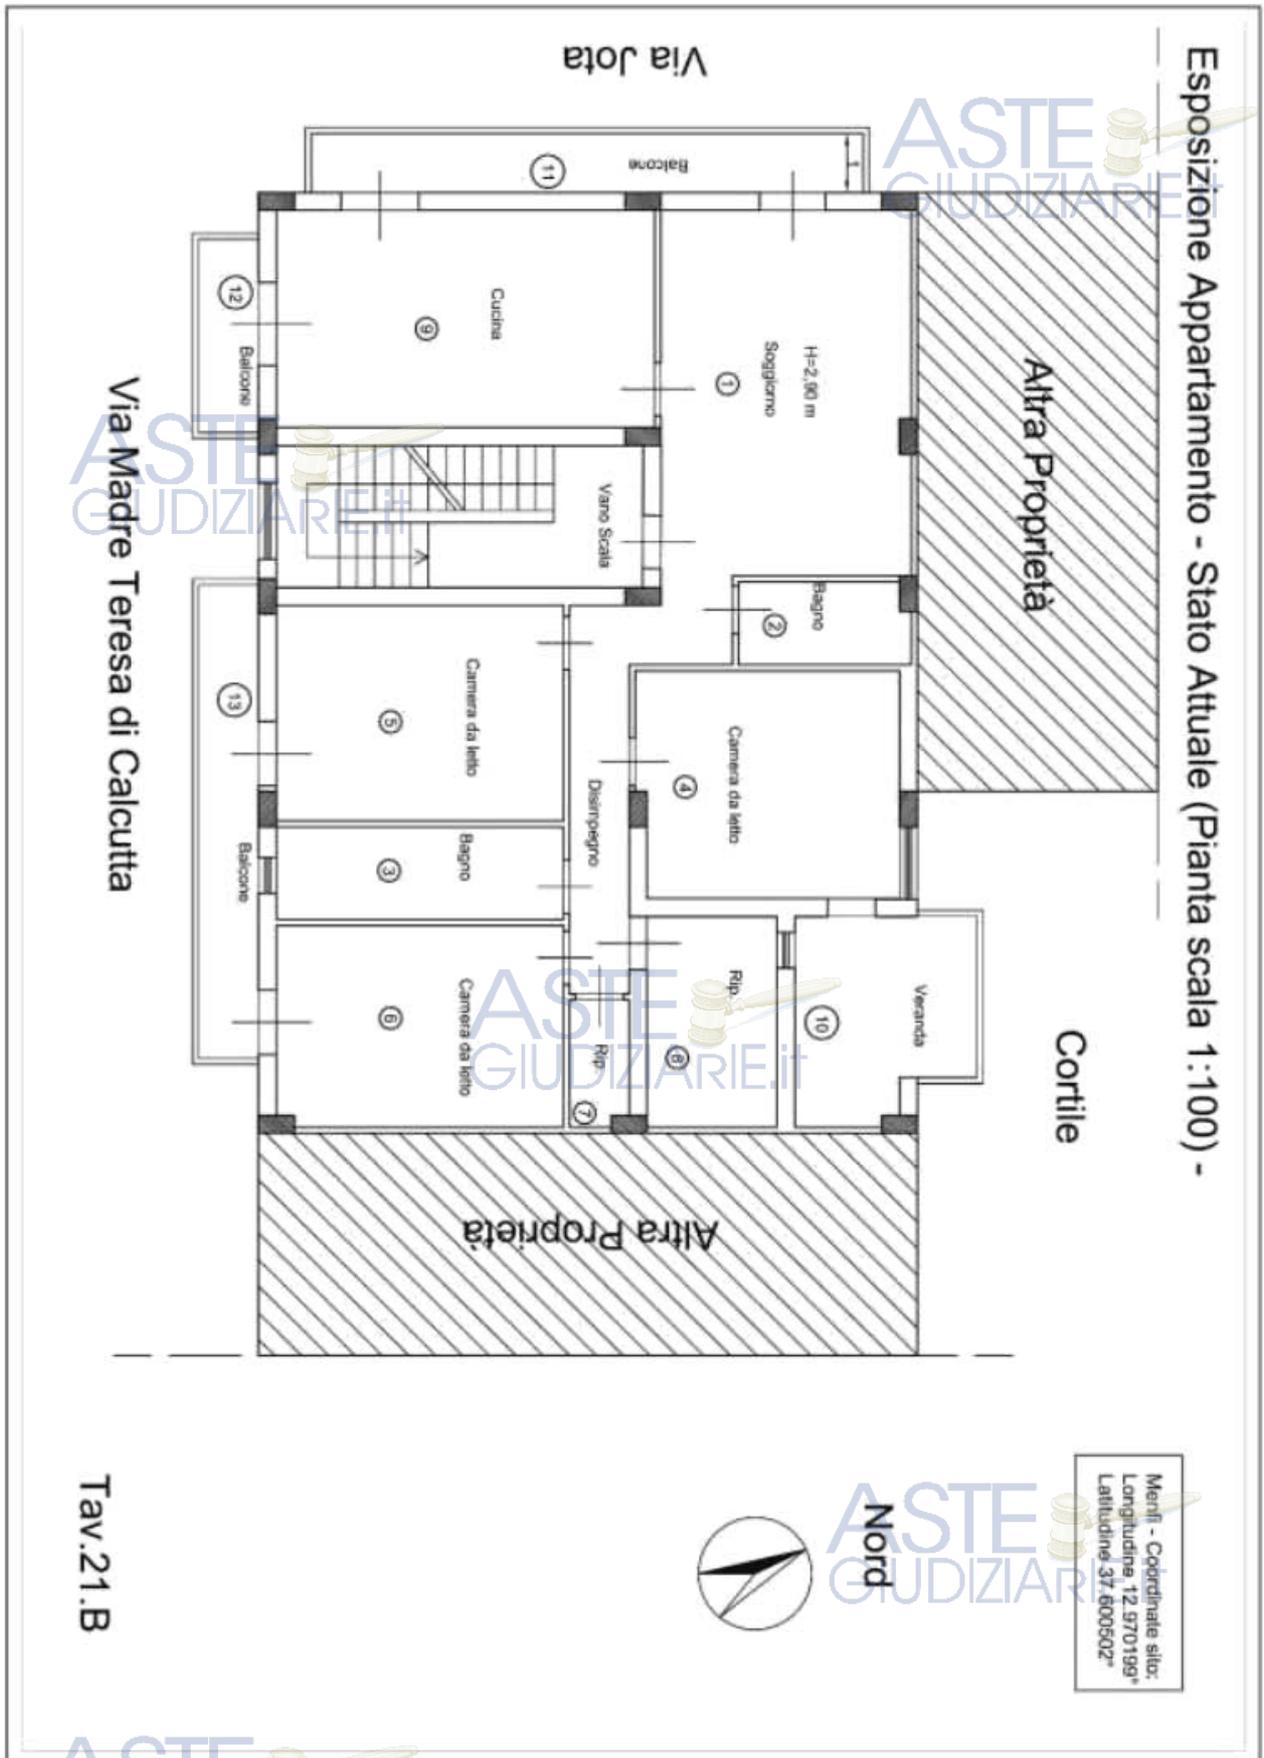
B - Esposizione via - Lotto 3 Immobile3.
